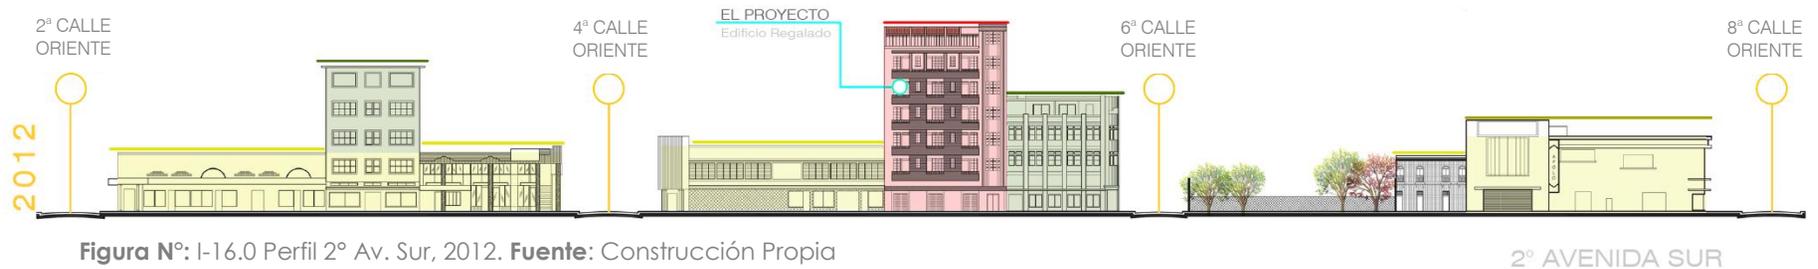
Perfil 2º Av. Sur, 2012. Fuente: Construcción Propia
